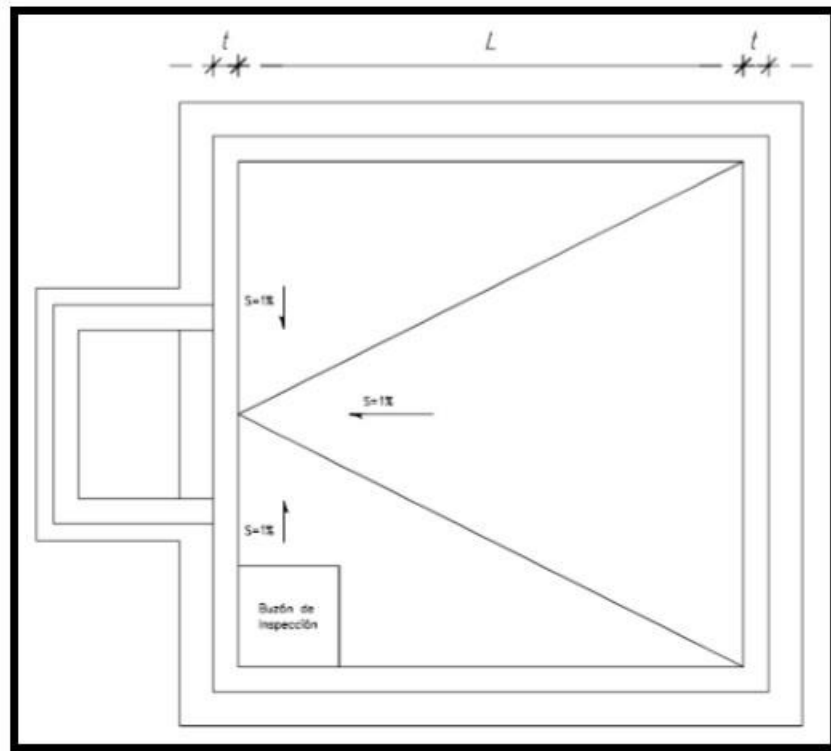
Plano en planta de un reservorio rectangular. Fuente: Agüero R. (2004)
